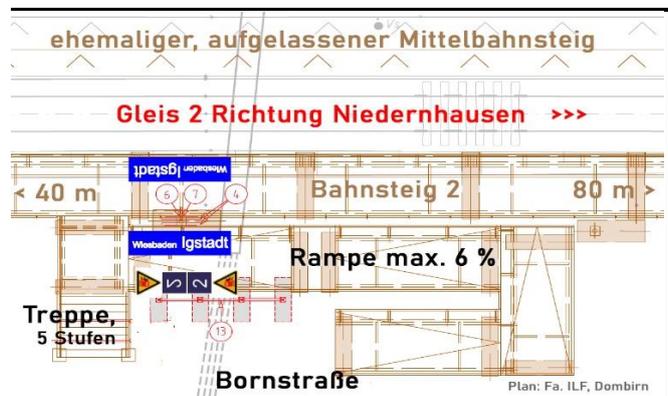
Planungsausschnitt mit Zugang zum Bahnsteig 2
